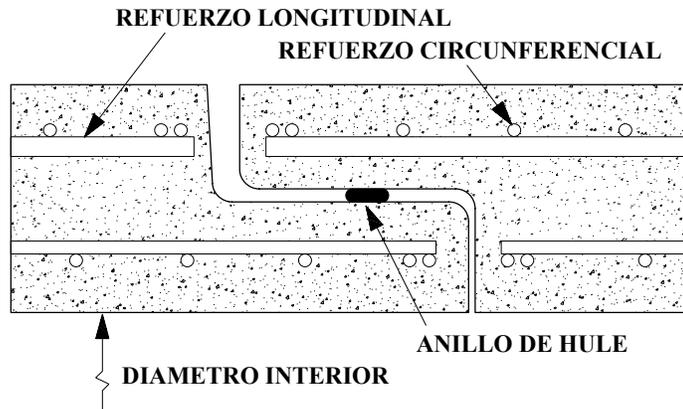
Unión espiga-campana en tuberías de concreto sin cilindro de acero
